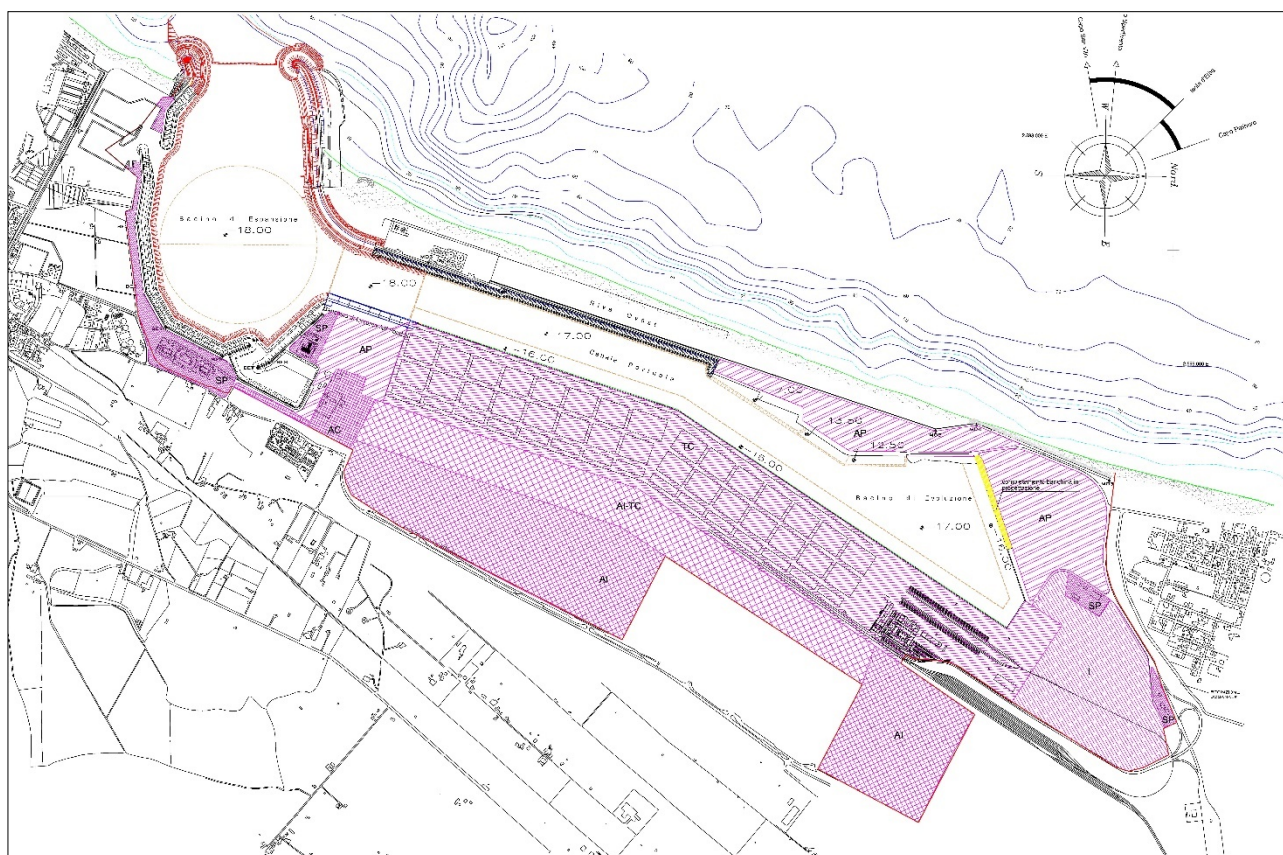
Stralcio ATF 2005 – Planimetria piano pescaggi vigente
